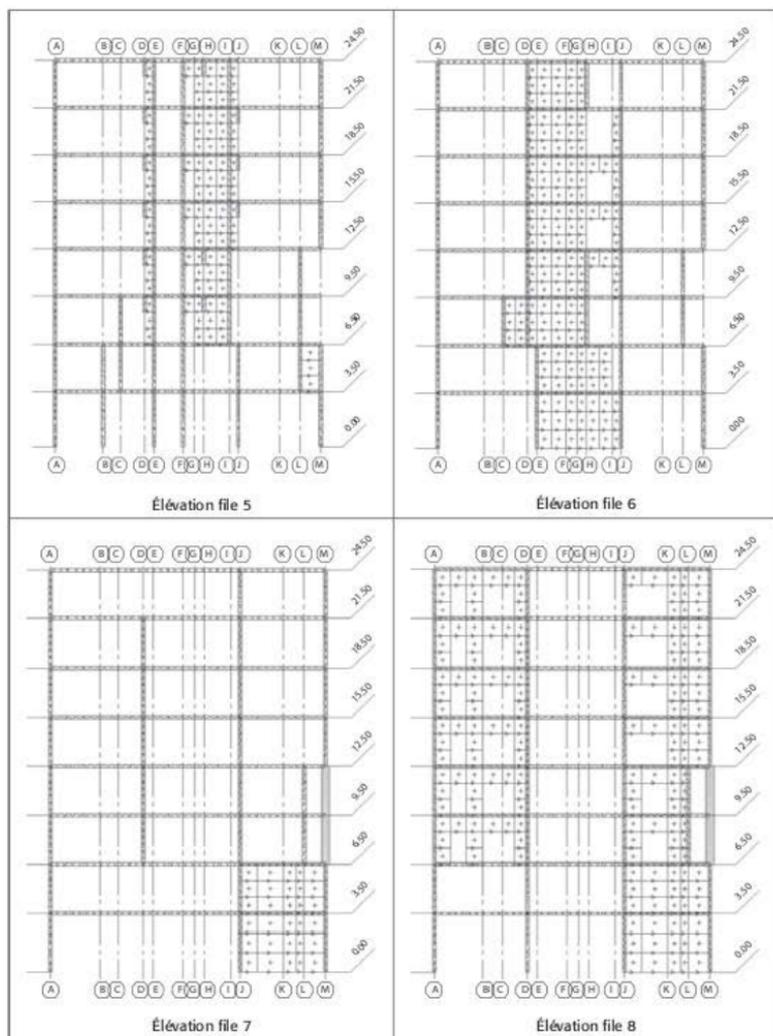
Élévation des voiles – plan YZ (2/3)
